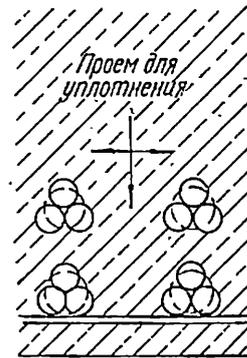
3. Группы из трех соприкасающихся стержней
